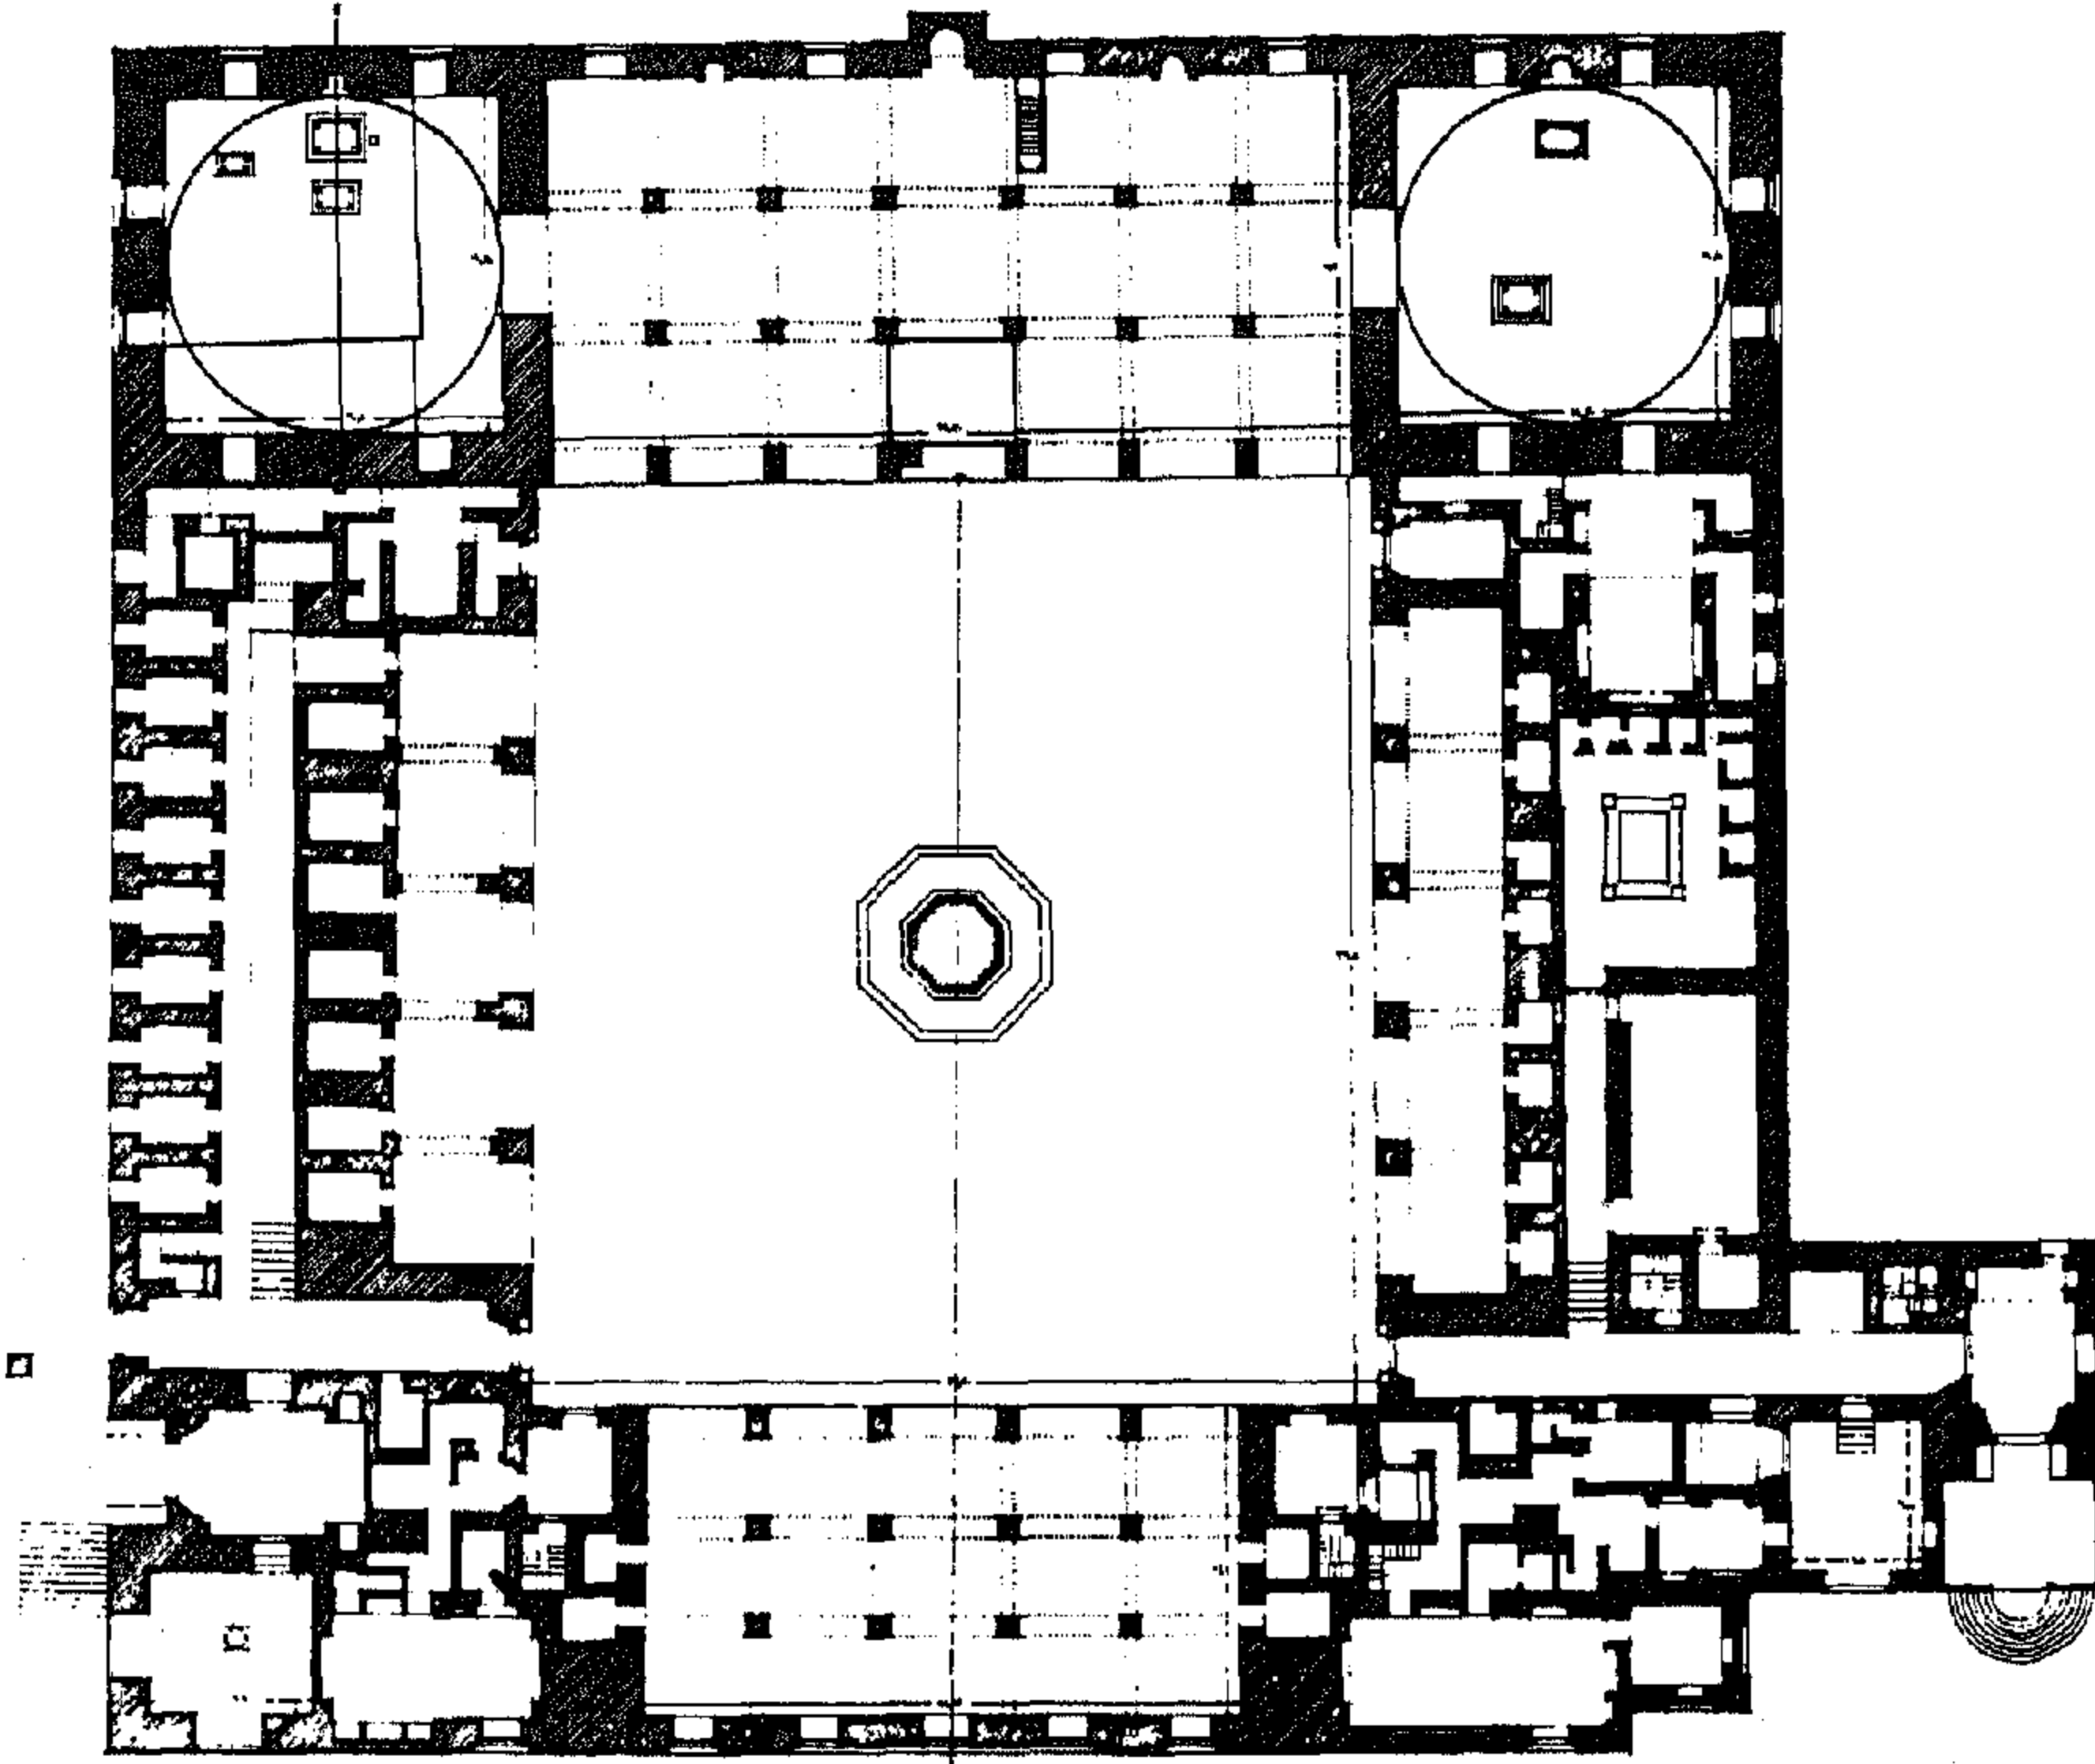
مسقط أفقي للجامع الأزهر
